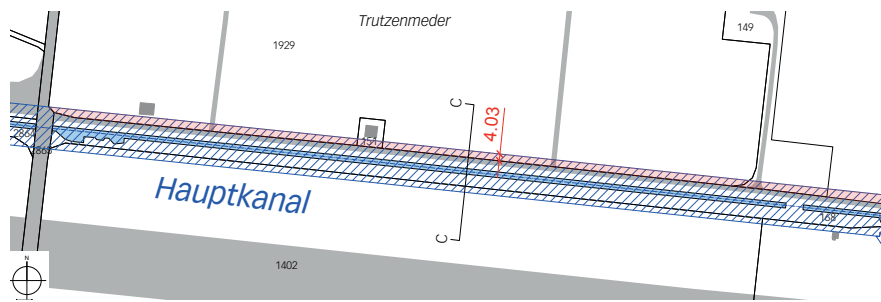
Planausschnitt Zonenplan Gewässerraum; rot: der zu prüfende Randstreifen
